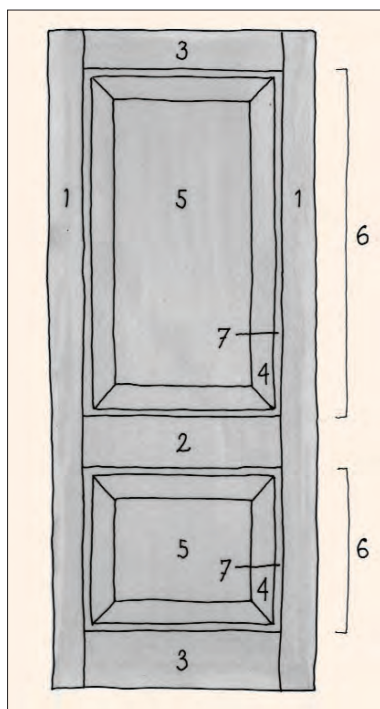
Detail van de houting op de tweepaneelsdeur.
